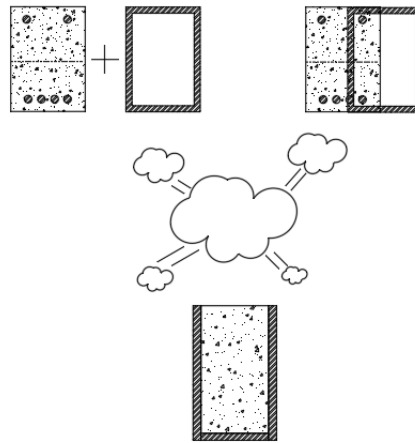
Combinación de las características de las vigas de Concreto R y Acero.
